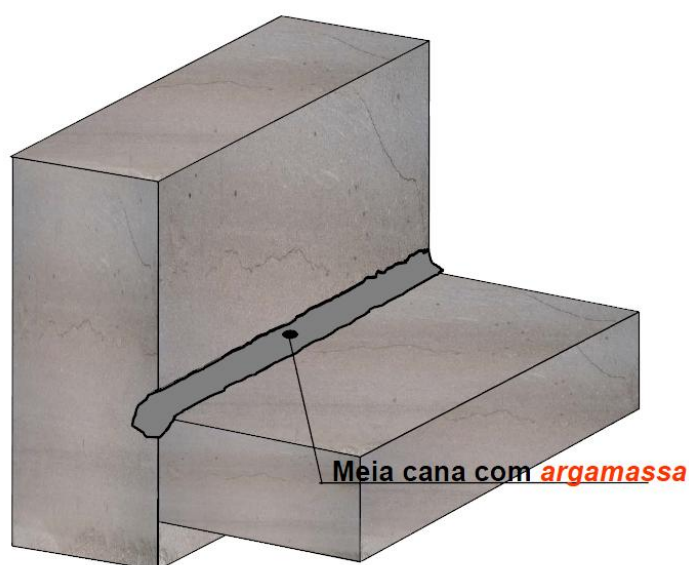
Execução de meia cana no encontro parede/pavimento (Ecofirma, 2010).
